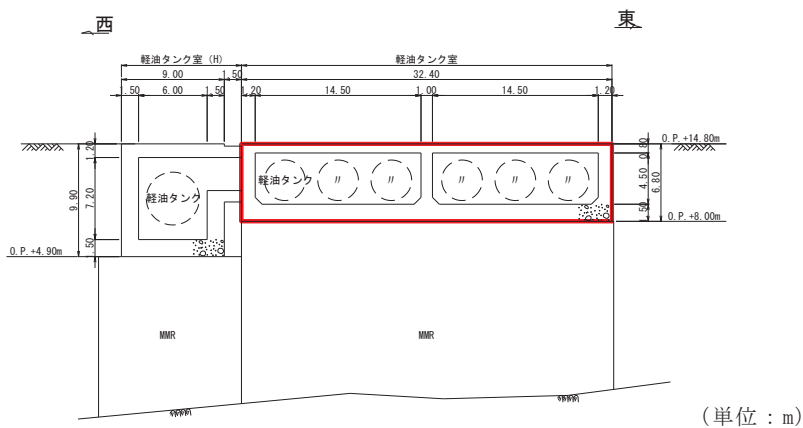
軽油タンク室断面図 (B-B 断面, 東西 (タンク室))
